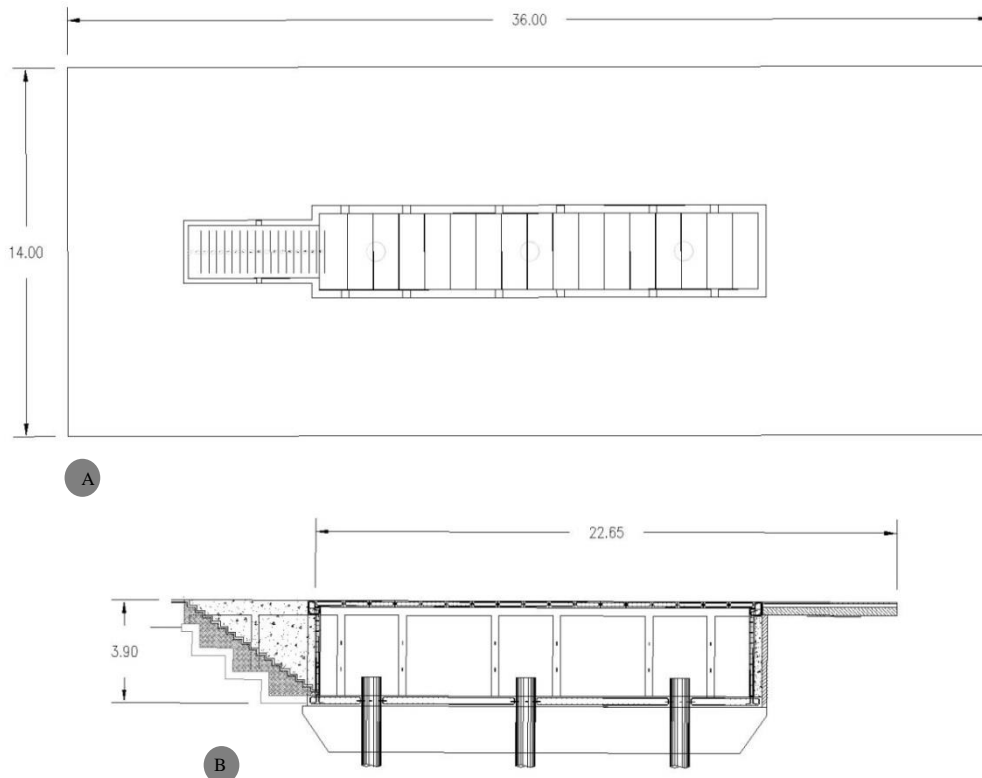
Diseño típico de Contrapozos en una plataforma de perforación. A) vista en planta; B) vista alzada.
